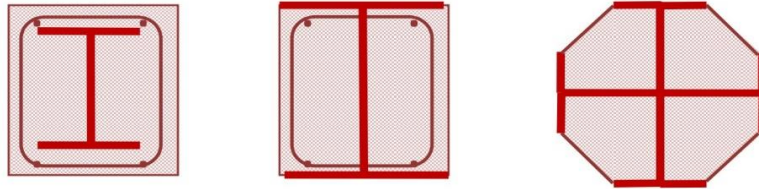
Diferentes perfiles mixtos embebidos de hormigón.
